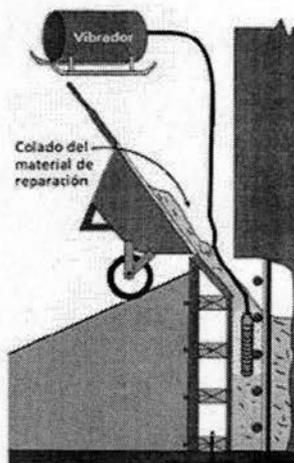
El método de pico de pájaro se utiliza para reparar cavidades verticales que no pueden ser llenadas desde la parte superior. La sección inclinada del molde permite que el material se coloque en éste desde un punto más alto que la parte superior de la cavidad, para permitir un llenado completo de la misma.
